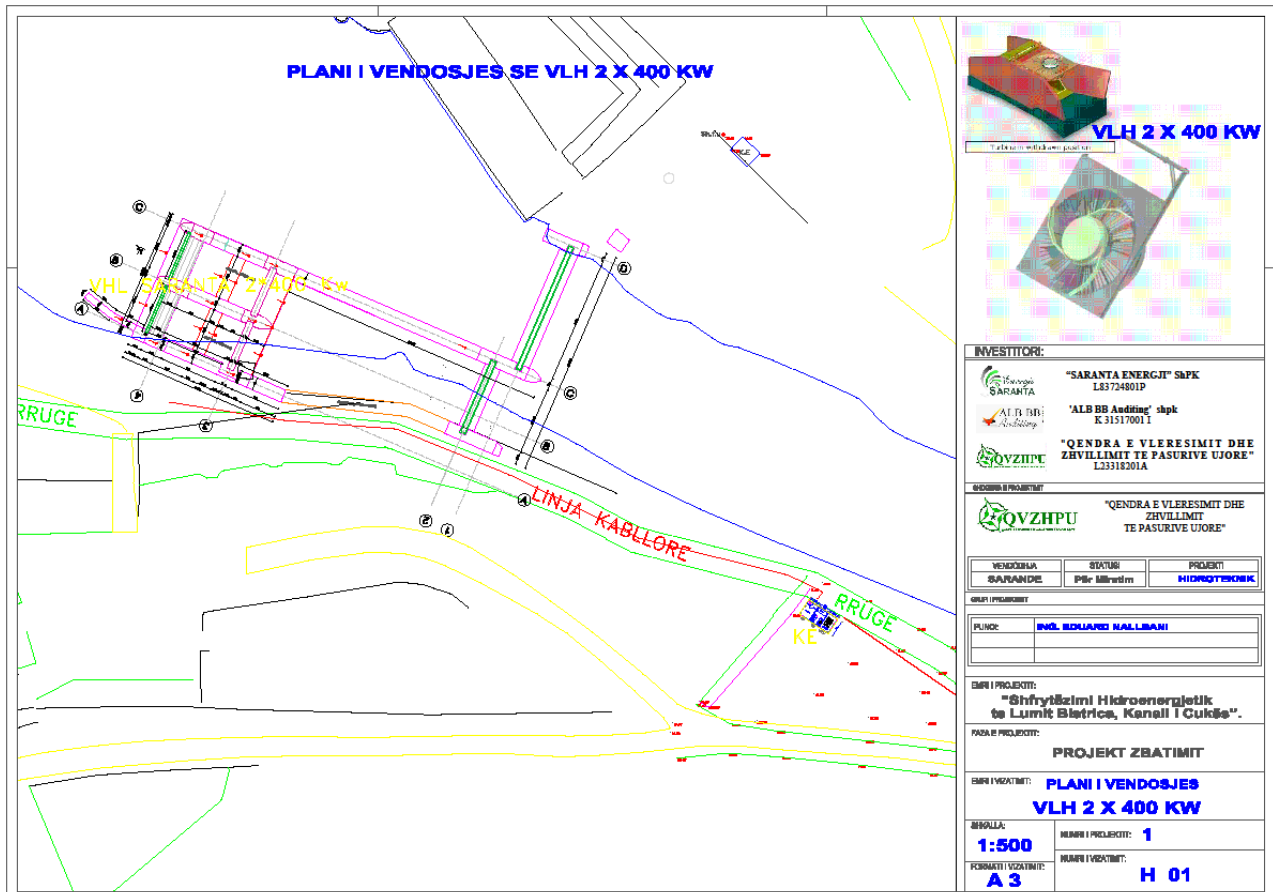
Planimetria e VLH 2X400 kW, SARANTA2
